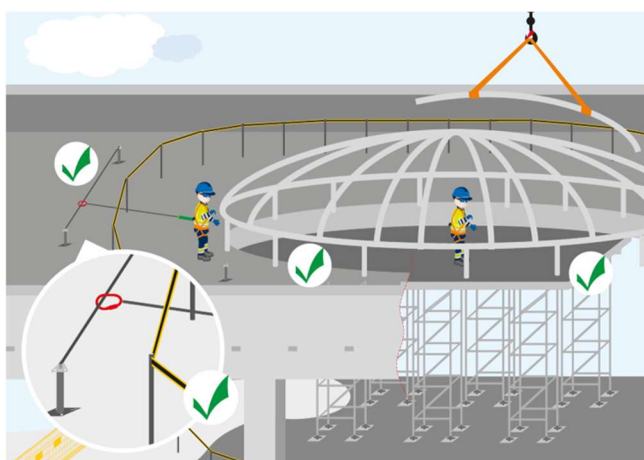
Oznakowanie strefy niebezpiecznej przy montażu konstrukcji
